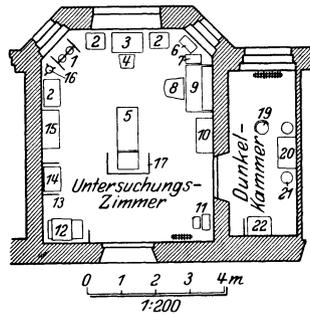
München-Schwabing, Städt. Krankenhaus, Sprechzimmer mit Dunkelraum.
